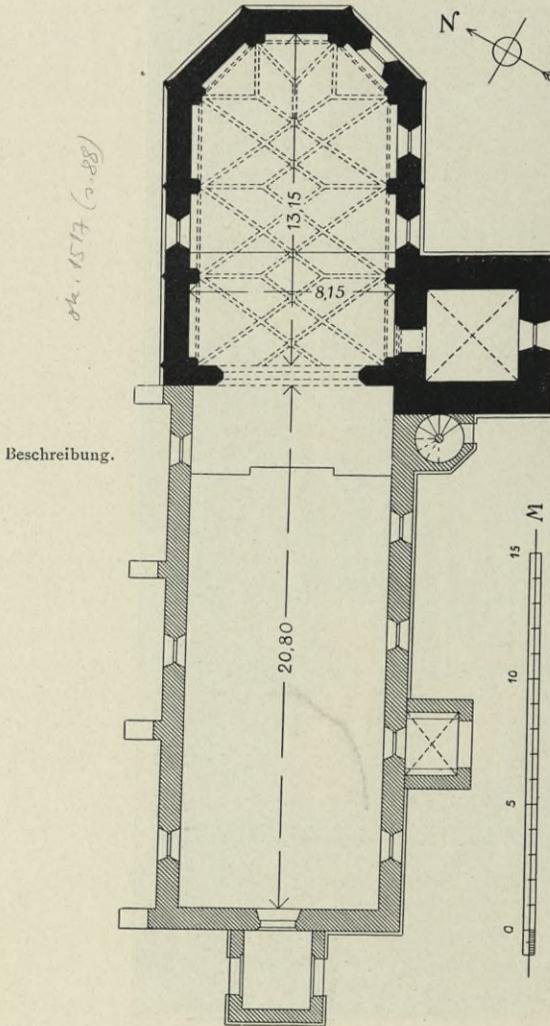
Eugenbach. Pfarrkirche. Grundriß.
